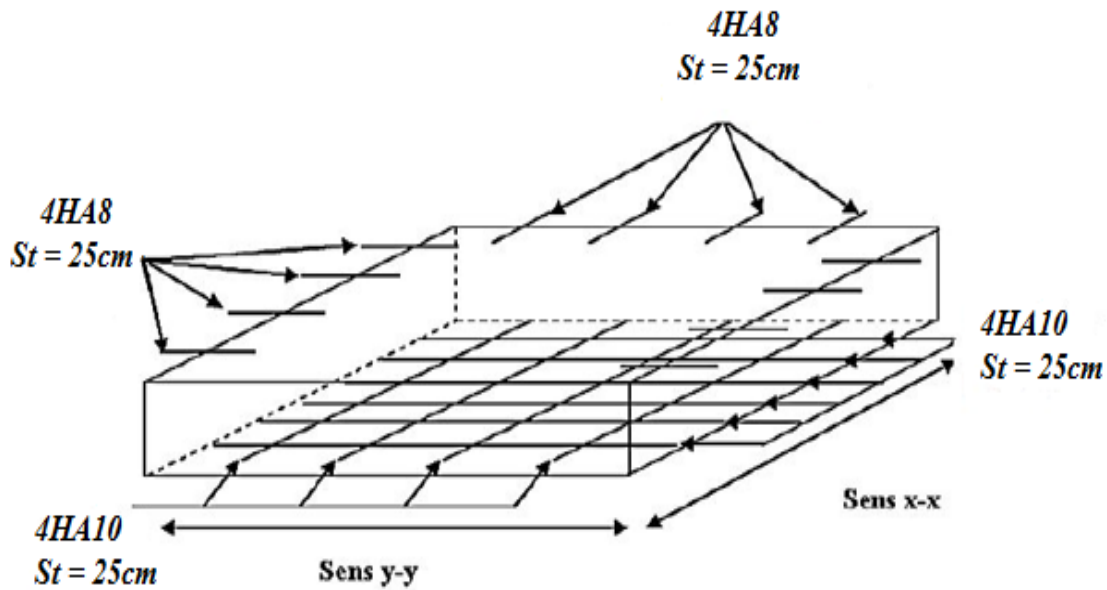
Schéma de ferrailage de la dalle sur quatre appuis (étage courant)
